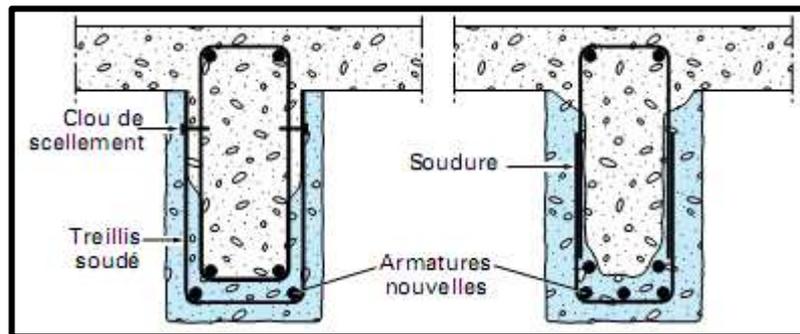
Armatures supplémentaires en surépaisseur de poutre. [57]
